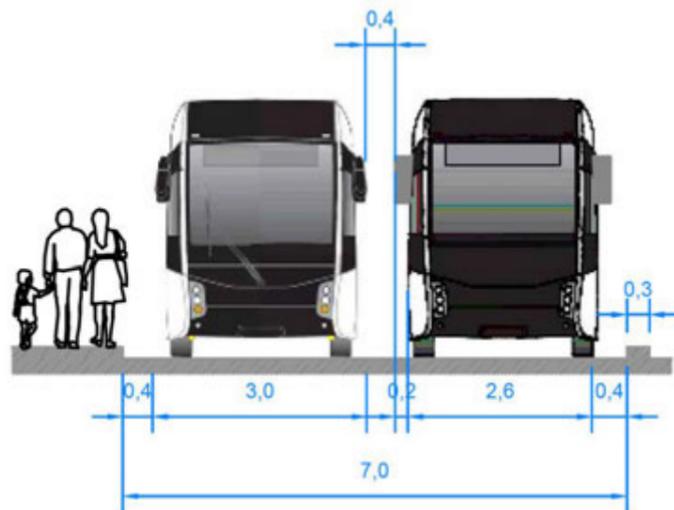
Coupe type de plateforme en section courante, 50km/h, insertion latérale entre bordures
